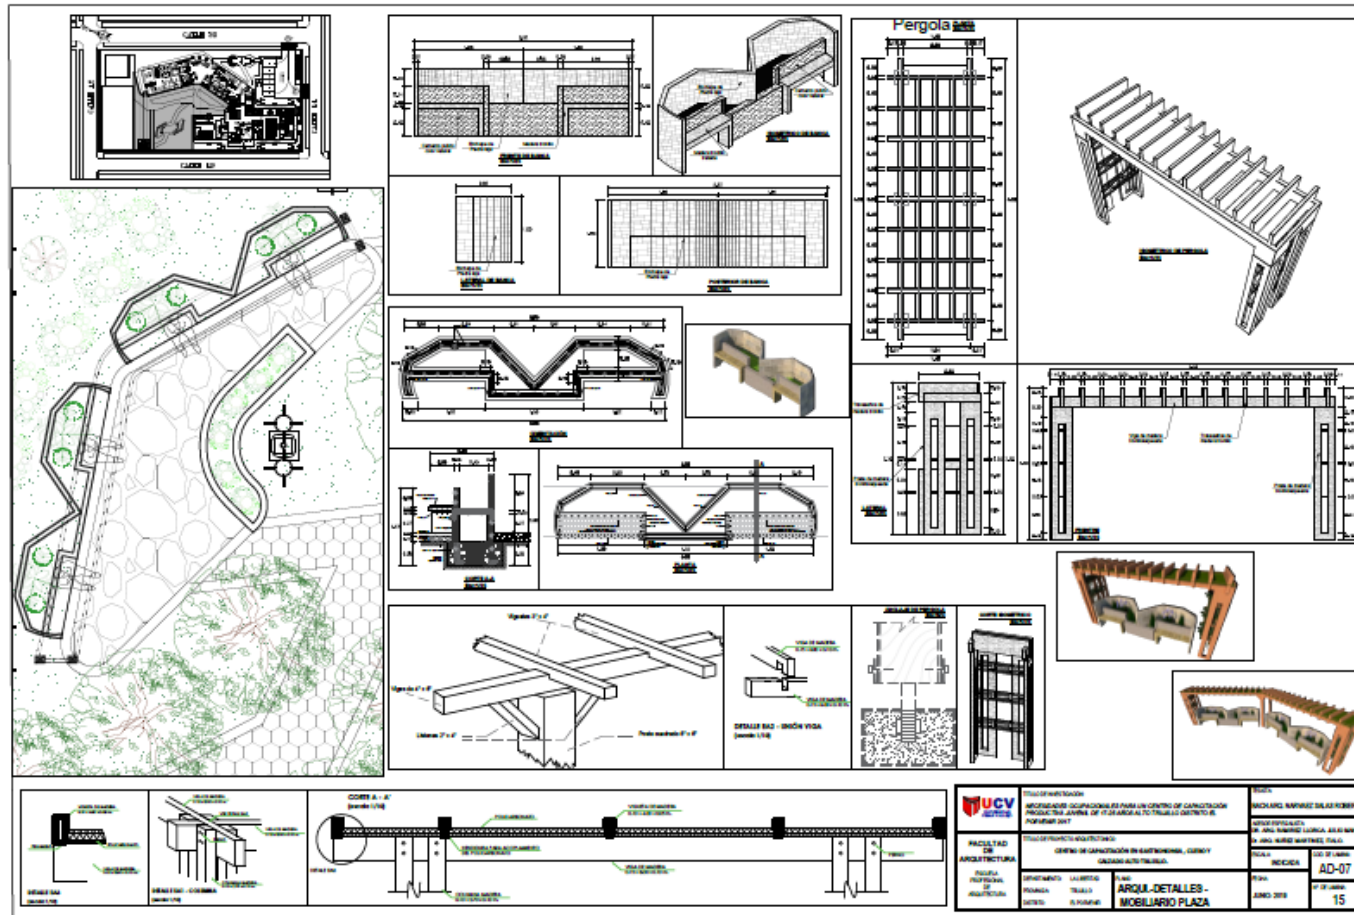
Plano de Detalle Arquitectónico, Detalle de mobiliario de plaza-Plano N°15-Lámina AD07
